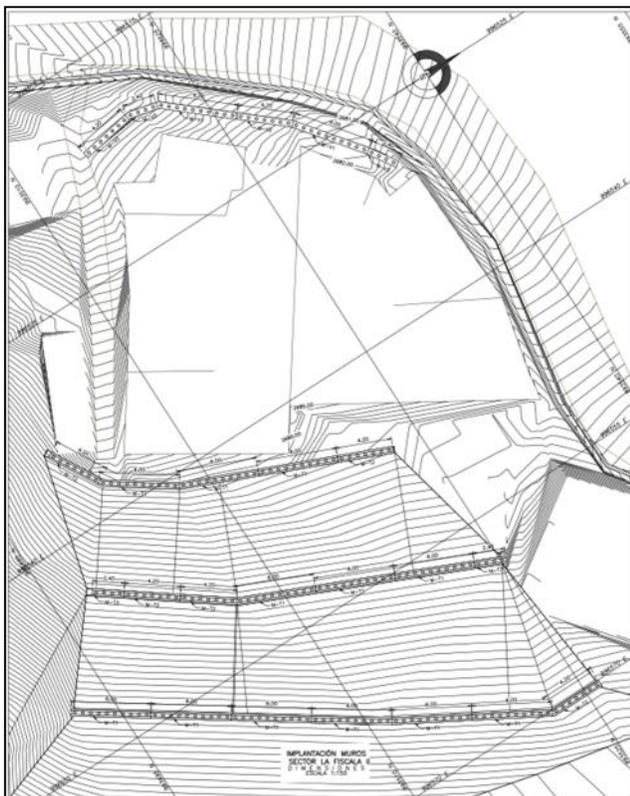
Plano obras estructurales. (Ver Anexo 6.1)
